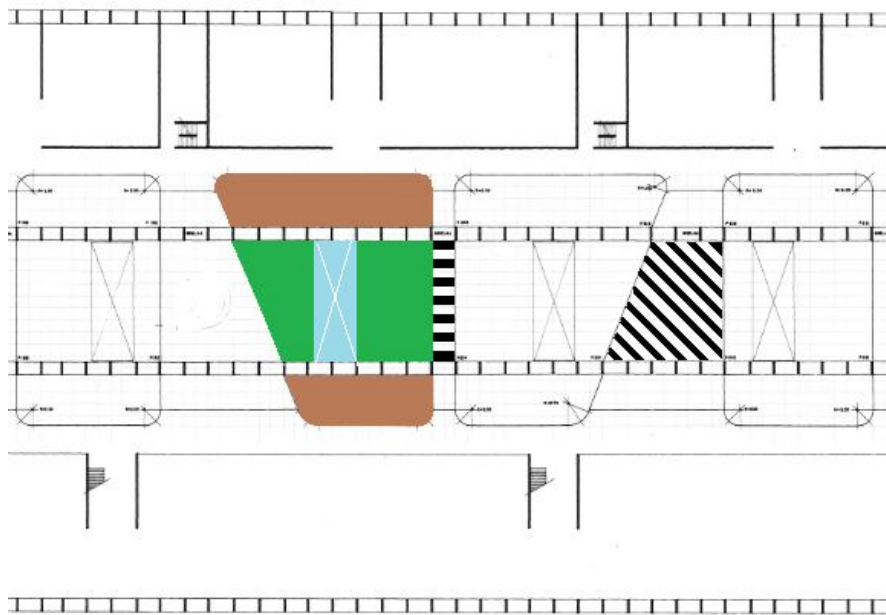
Composição do jardim do ICC. Marrom: Canteiro; Verde: Área gramada; Azul: Vão; Hachurado horizontal: Caminho; Hachurado transversal: Praça.
